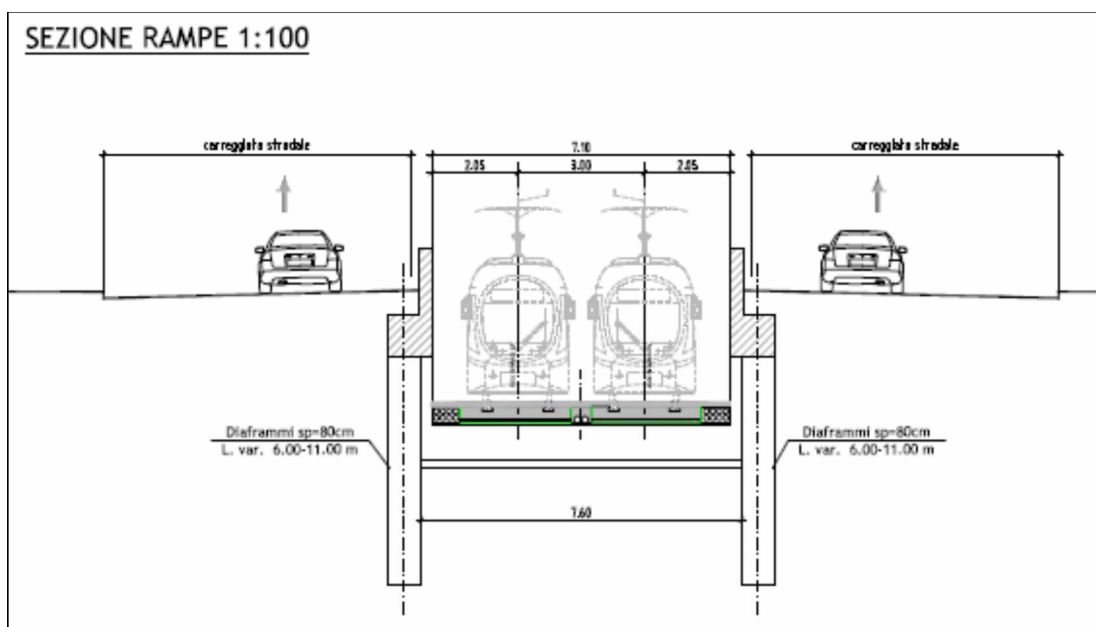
Sezione trasversale rampe di accesso (estratto da elaborato B831-C-SF-STR-RT002A)
